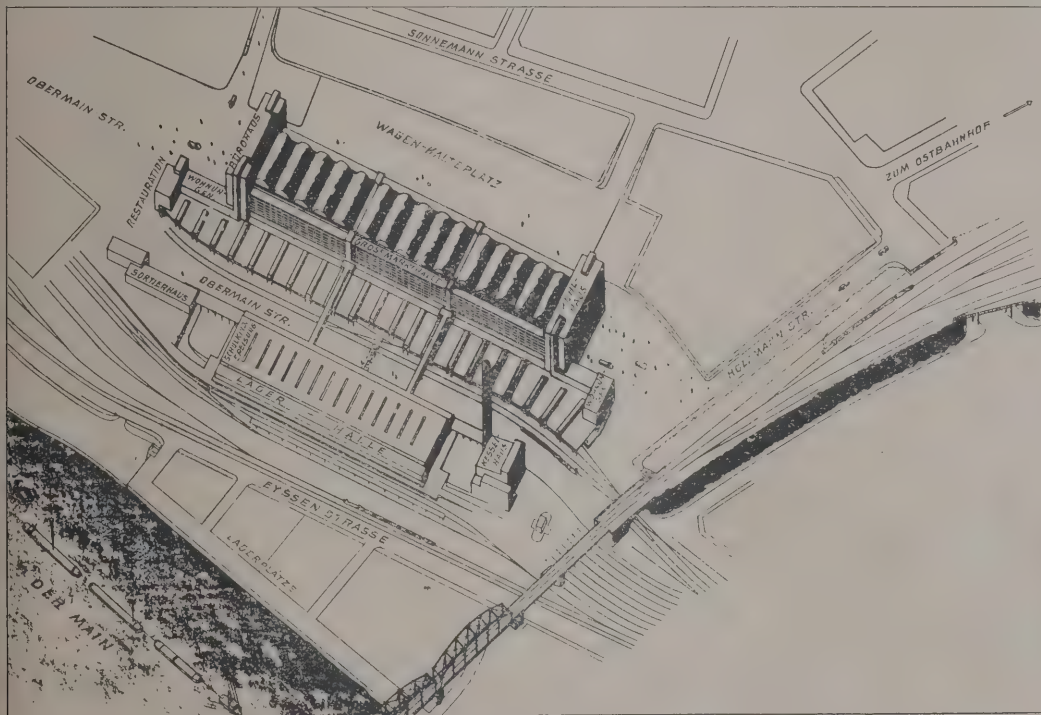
Grundriß der neuen Großmarkthalle mit Verladebahnhof und Lager-(Import-) Halle.
